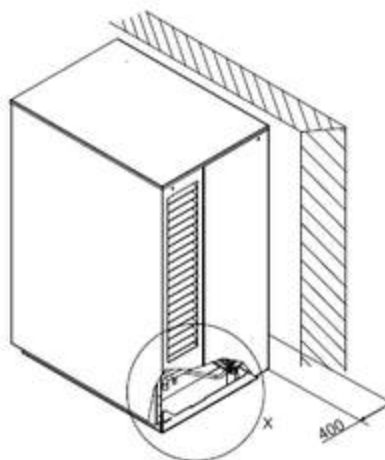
Installation de l'unité extérieure M Flex et du système M Comfort
